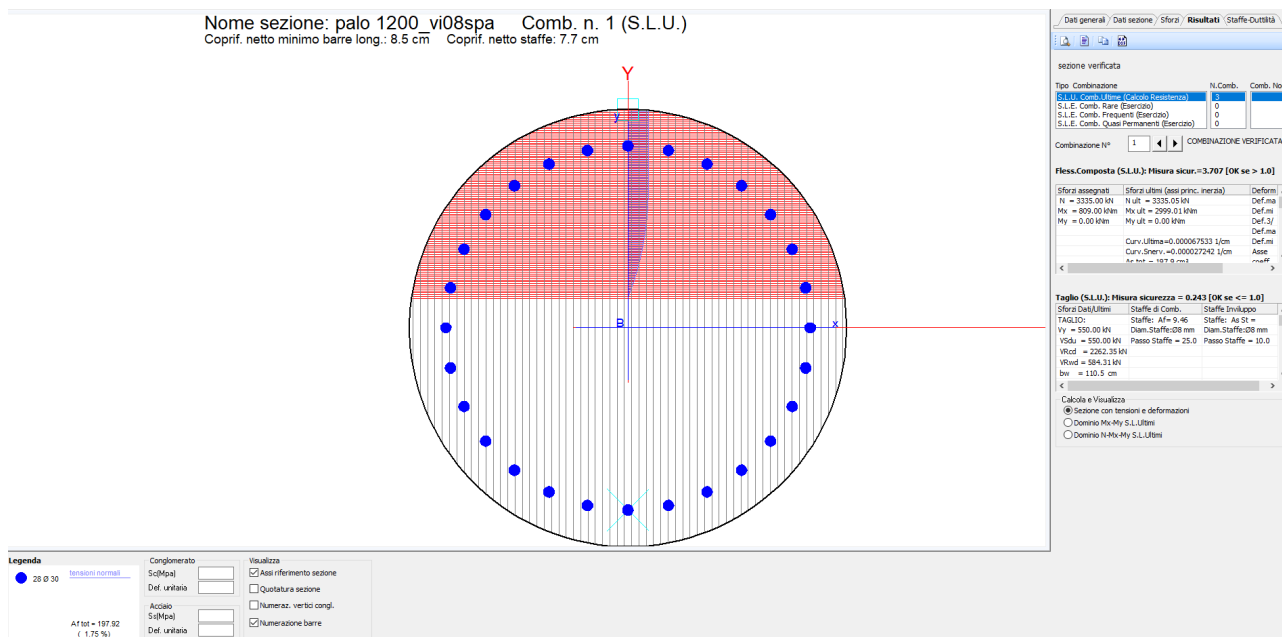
Verifica strutturale pali spalle (SLV)
